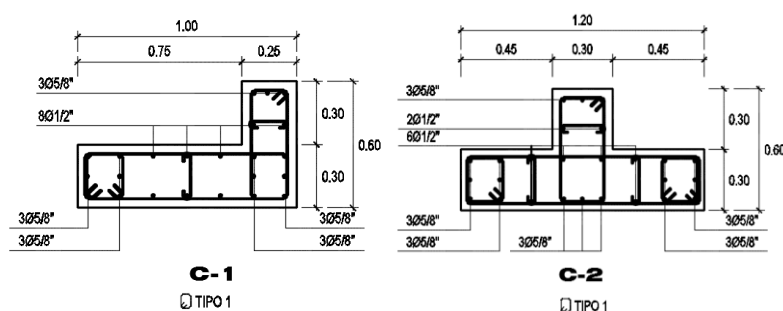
Configuración de Asignación de la columna C-1 y C-2.
